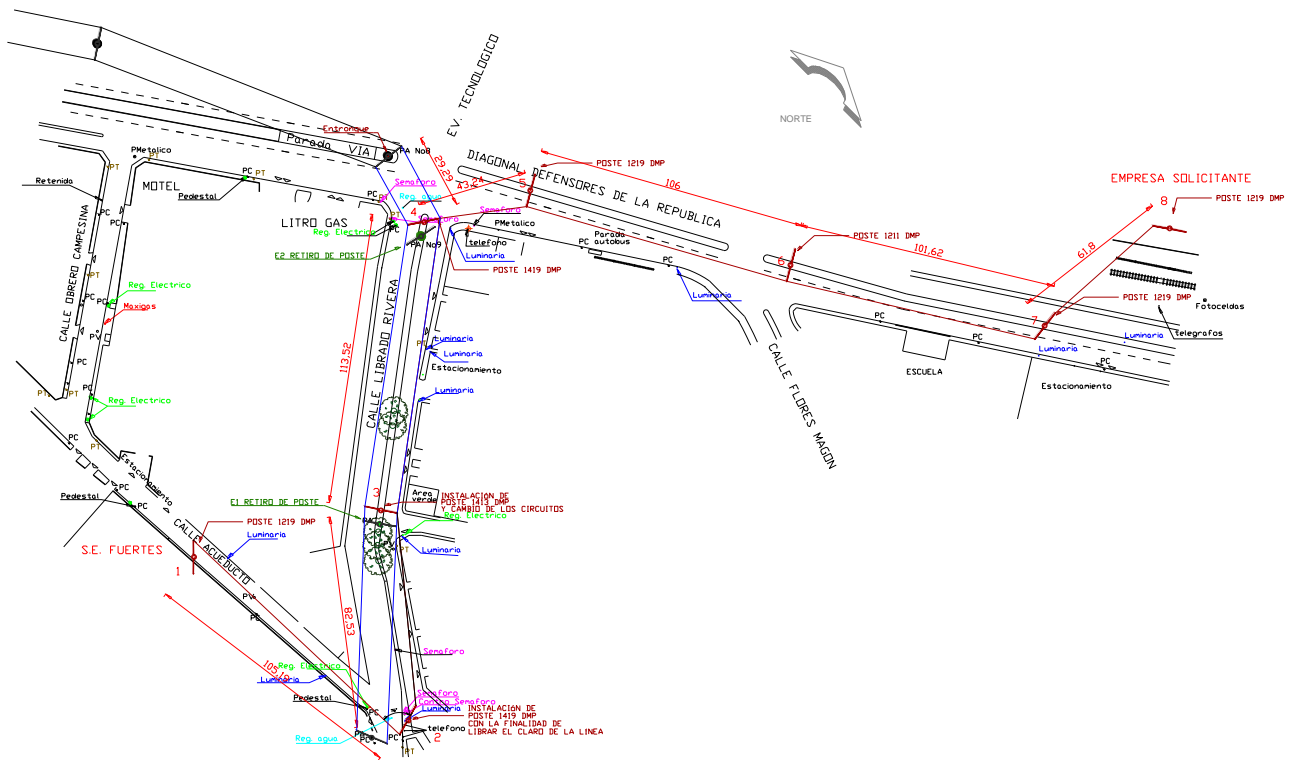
Plano de Planta, Proyecto Aéreo. (Fuente: Propia)
